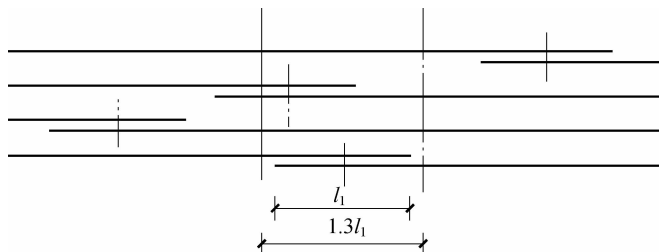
同一连接区段内的纵向受拉钢筋绑扎搭接接头
